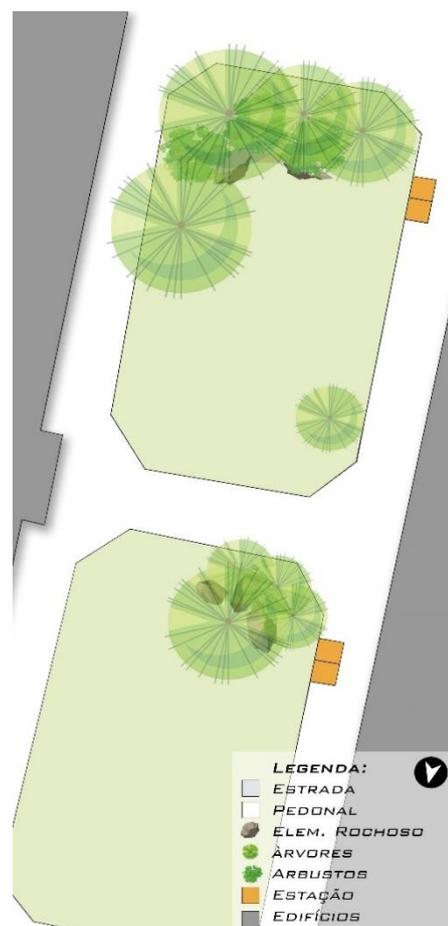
Planta da Estação E8 e E9, Pedrinhas
